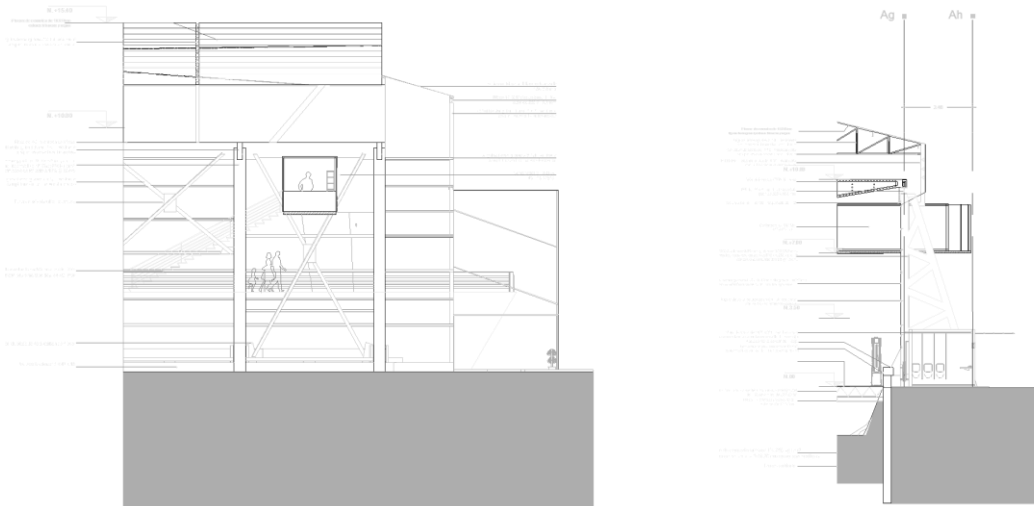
Cortes en donde se muestran detalles, de que los nuevos elementos no afectan estructuralmente al edificio antiguo ya así respetar los conceptos propuestos de reversibilidad y autenticidad. Para apreciar con mayor claridad los planos del proyecto ir a los anexos.
